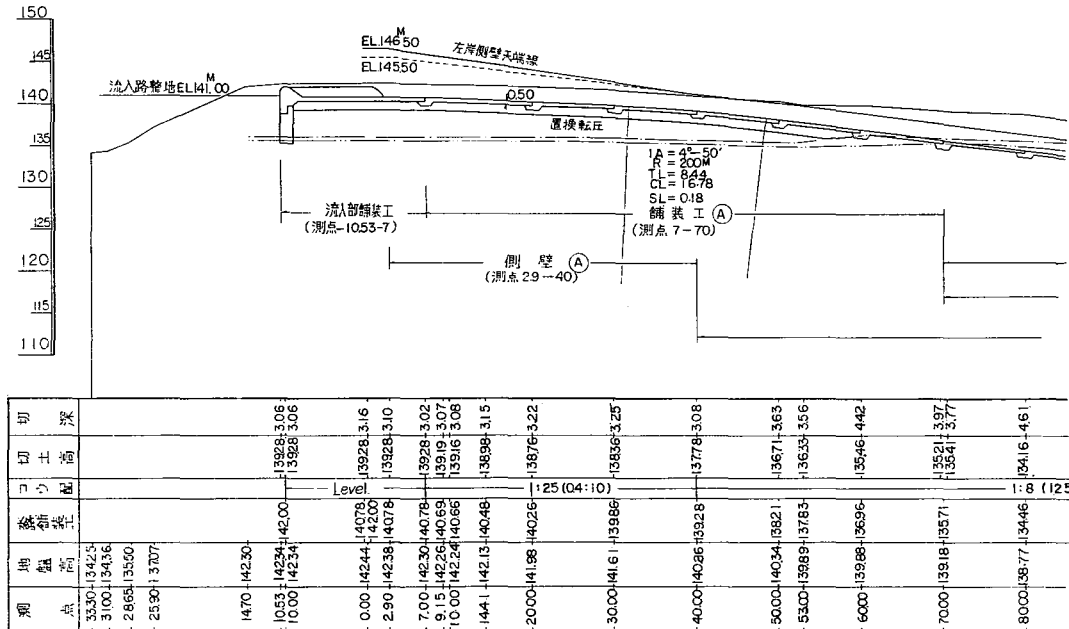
北海道青山ダム余水吐放水路縦断面図 [I]
